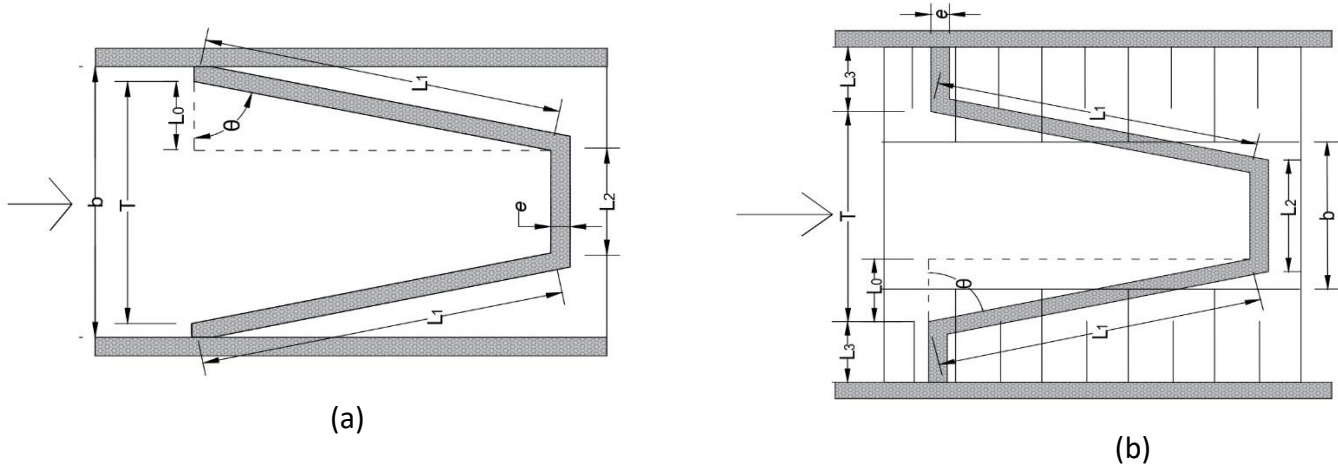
Parámetros vertedero de cresta larga para: (a) canal rectangular (b) canal trapezoidal. Vista en planta. Fuente: Elaboración propia.
